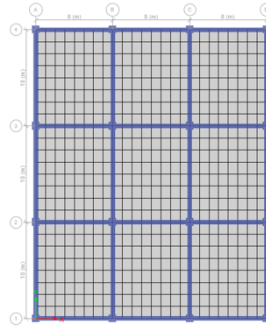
Planta de modelo de 30 niveles orientado en Eje X
